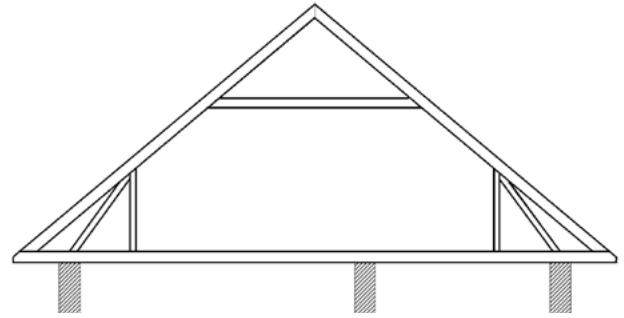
Studiobinder mit Untergrurt (Deckenbalken)
